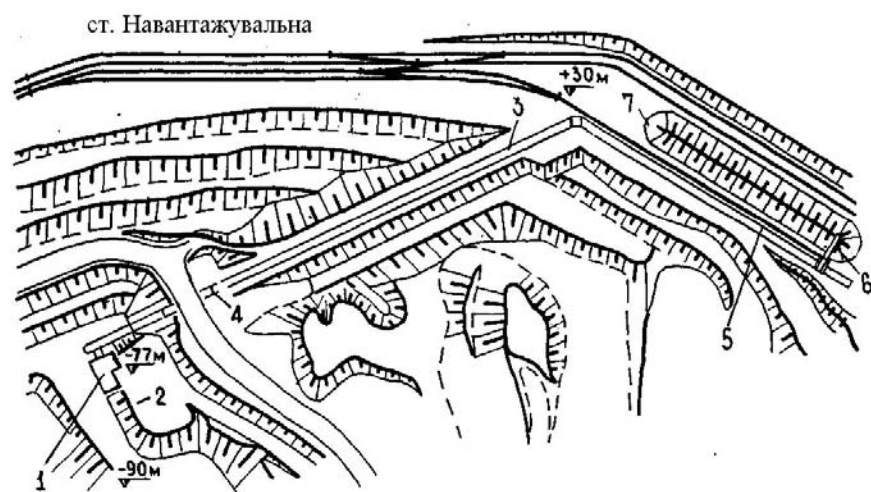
Схема встановлення конвеєрного підйомника на кар'єрі Полтавський ГЗК: 1 – пересувна дробарка крупного дроблення фірми "Крупп"; 2 – розвантажувальна площадка для автосамоскидів; 3 – похилий
